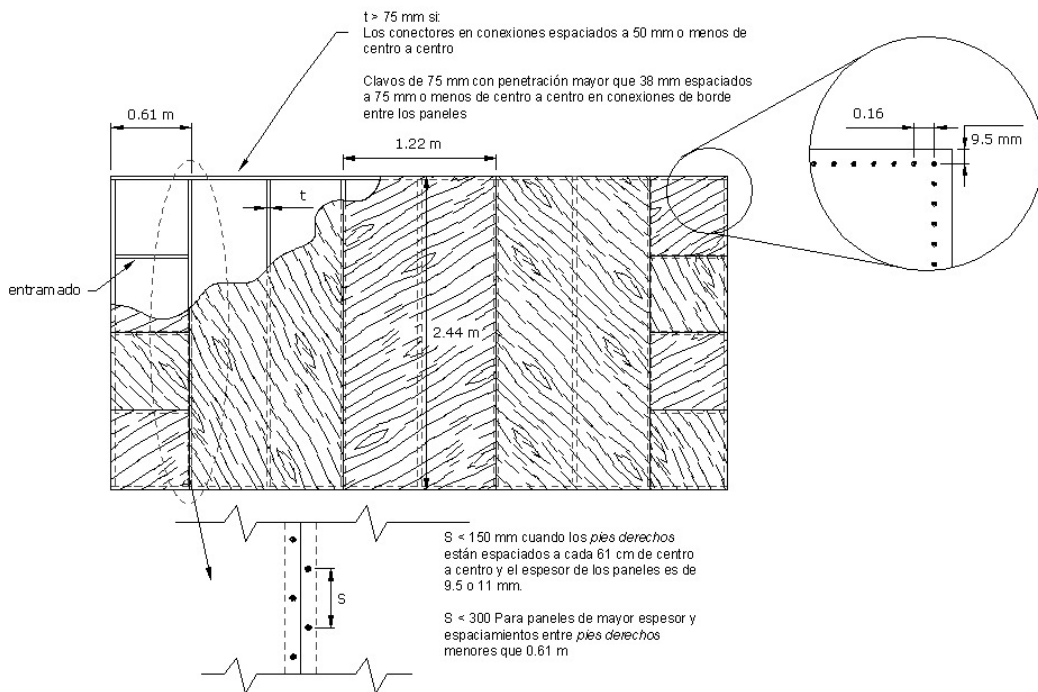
Muros de cortante forrado con paneles estructurales.
